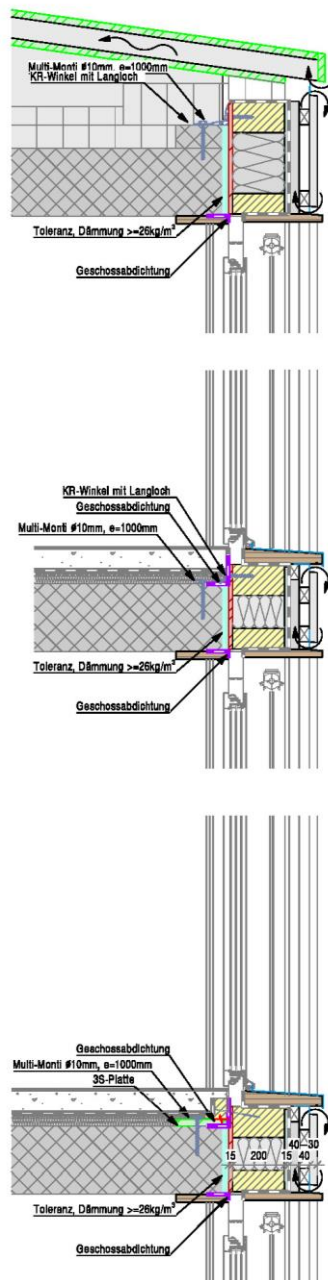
Planausschnitt Detailierung Bauprojekt durch den Holzbauingenieur
